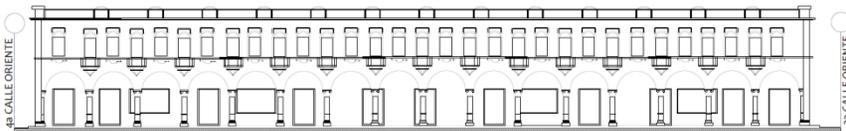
Perfil 4a Avenida Sur, San Salvador
